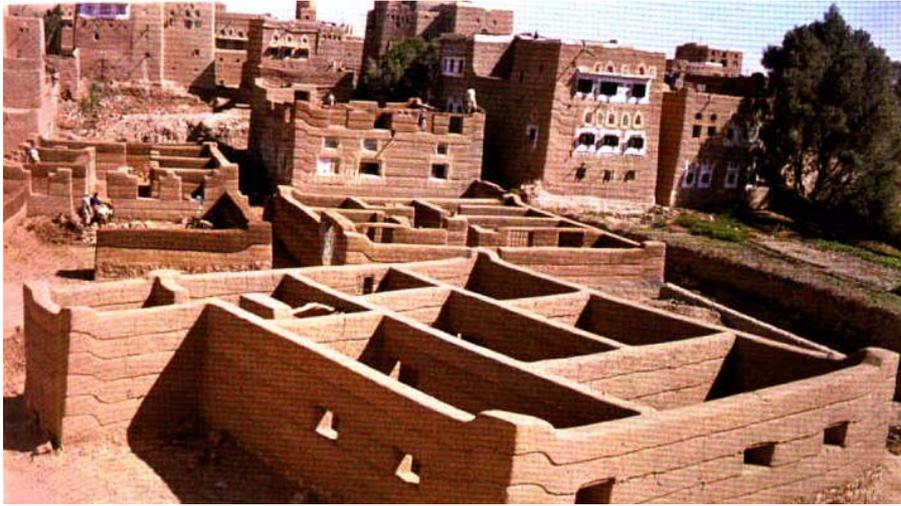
a) Edificios en construcción con la técnica del Zabour. Destacan las sobreelevaciones de las hiladas de las esquinas.
